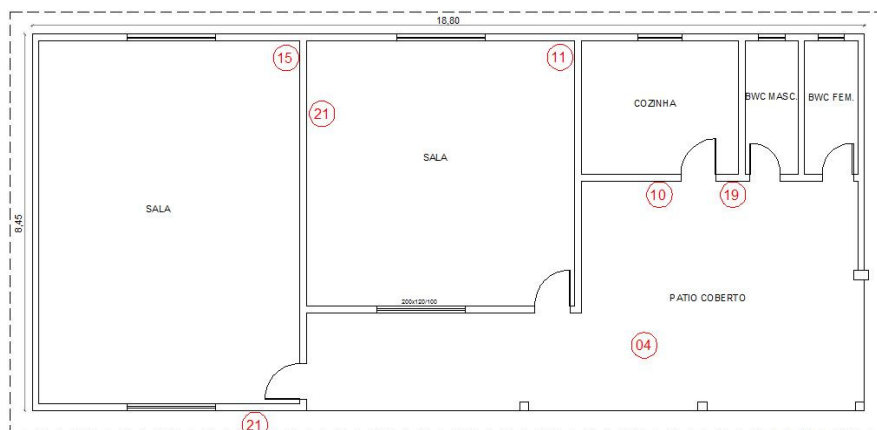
Planta Baixa creche Cinderela – Bairro Marili
